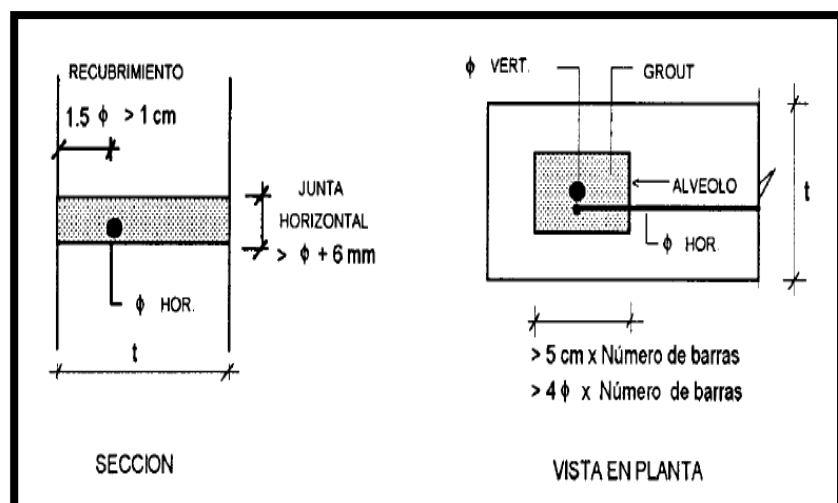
Muro armado su recubrimiento y dimensiones mínimas de los alveolos. (Fuente: Ángel San Bartolomé, Construcciones de Albañilería-Comportamiento Sísmico y Diseño Estructural”).
